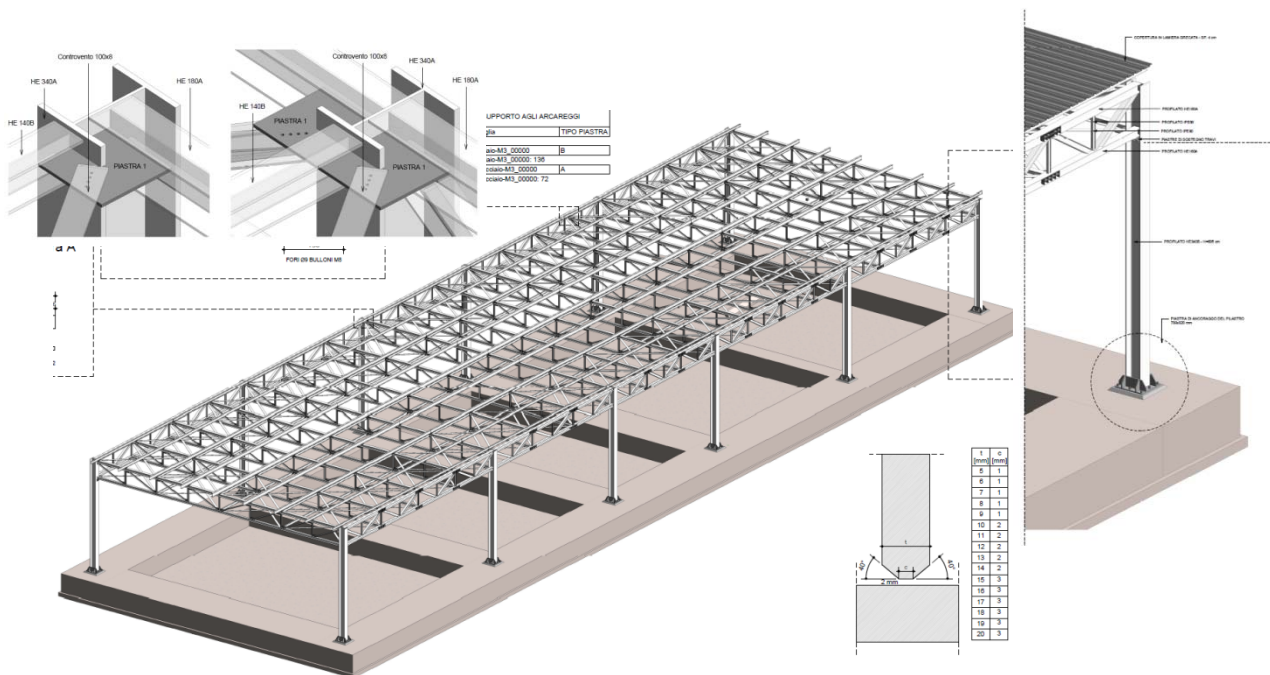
Rifornimento carburanti -Strutture - Vista prospettica e dettaglio nodi
